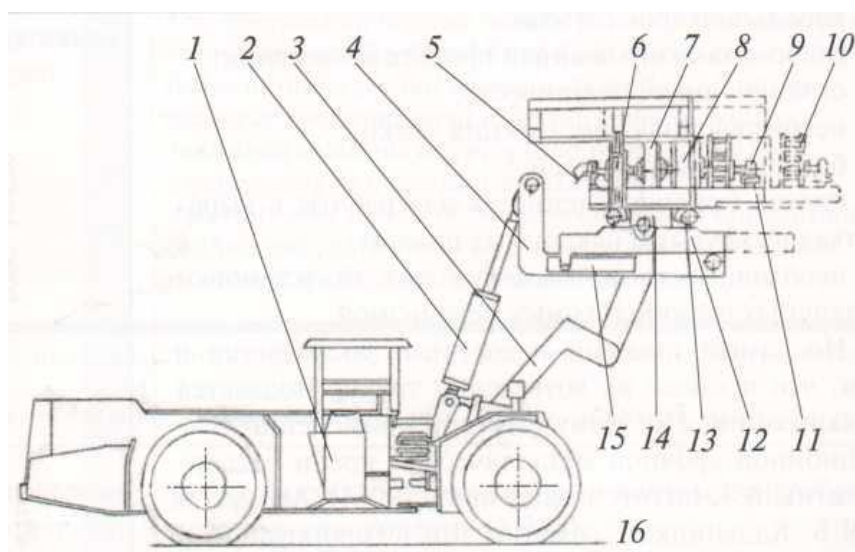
Машина центробежного торкретирования в рабочем положении 1-транспортное средство; 2- гидроцилиндр; 3- рукоять; 4- платформа; 5- гидромотор; 6- гидроцилиндры; 7- планетарный редуктор; 8-приемный бункер; 9- подшипниковая опора; 10- рабочее колесо; 11- нагнетатель; 12- рама; 13- ролики; 14- гидрореечный механизм; 15- дополнительный бункер; 16- направляющая.
